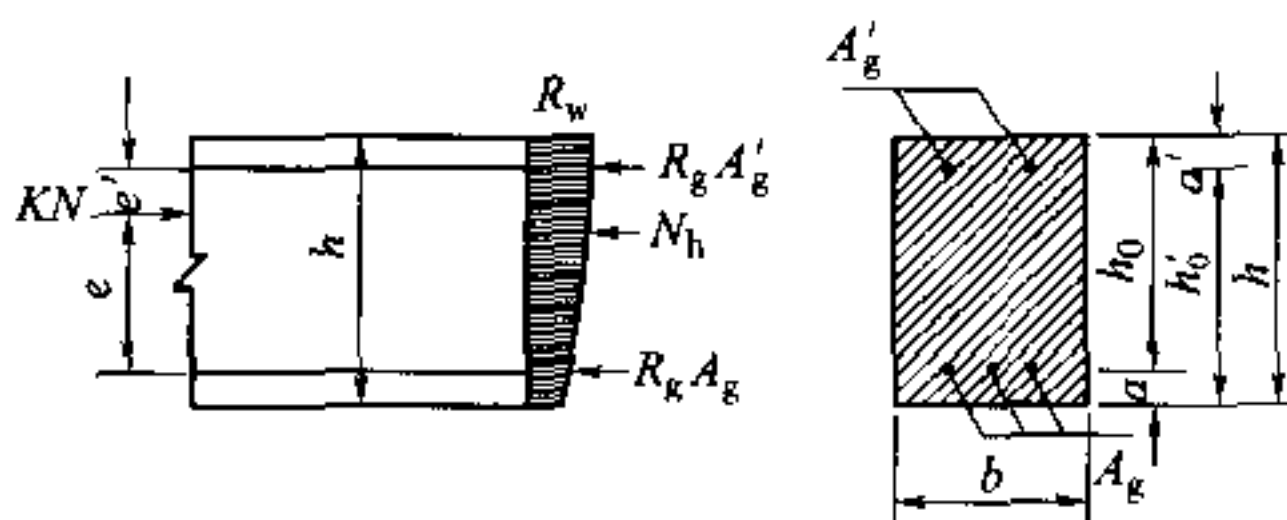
钢筋混凝土小偏心受压构件截面强度计算
